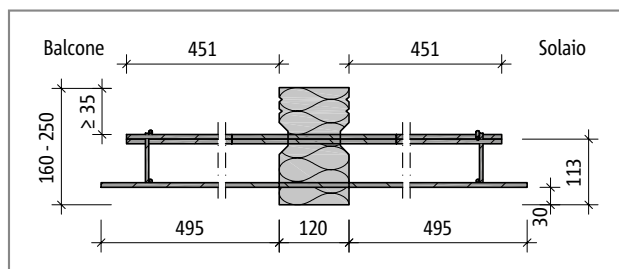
Schöck Isokorb® tipo EQXT1: sezione dell'elemento
